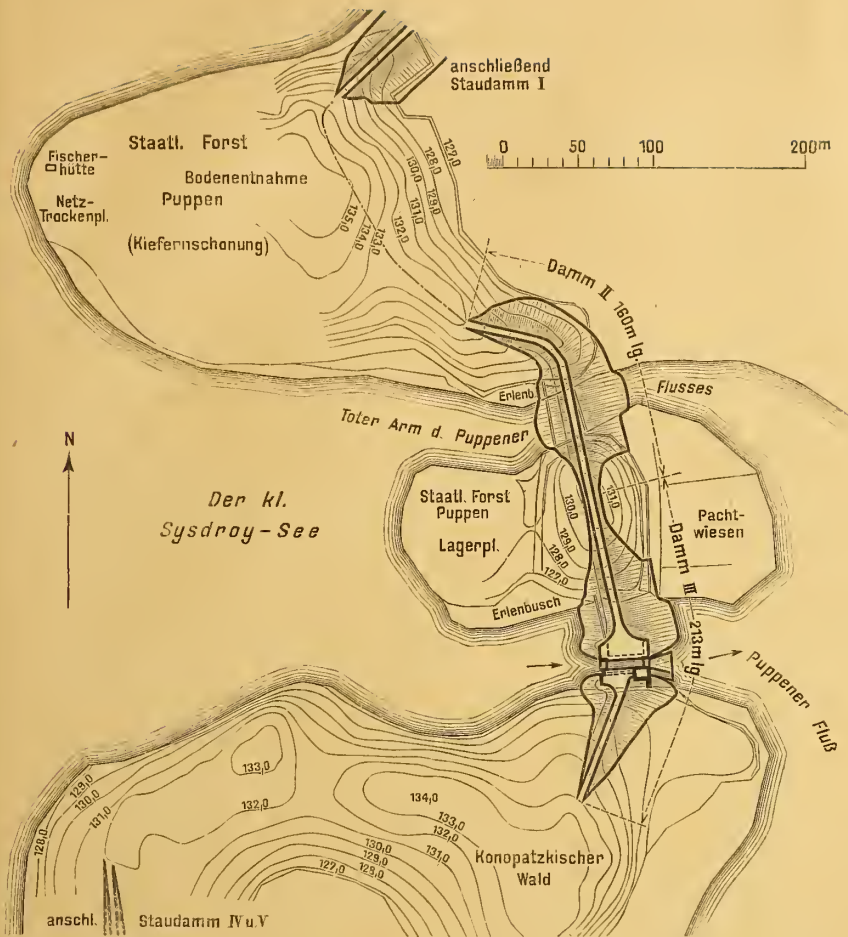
Lageplan des Staudammes und der Schleuse am Sysdroy-See.
